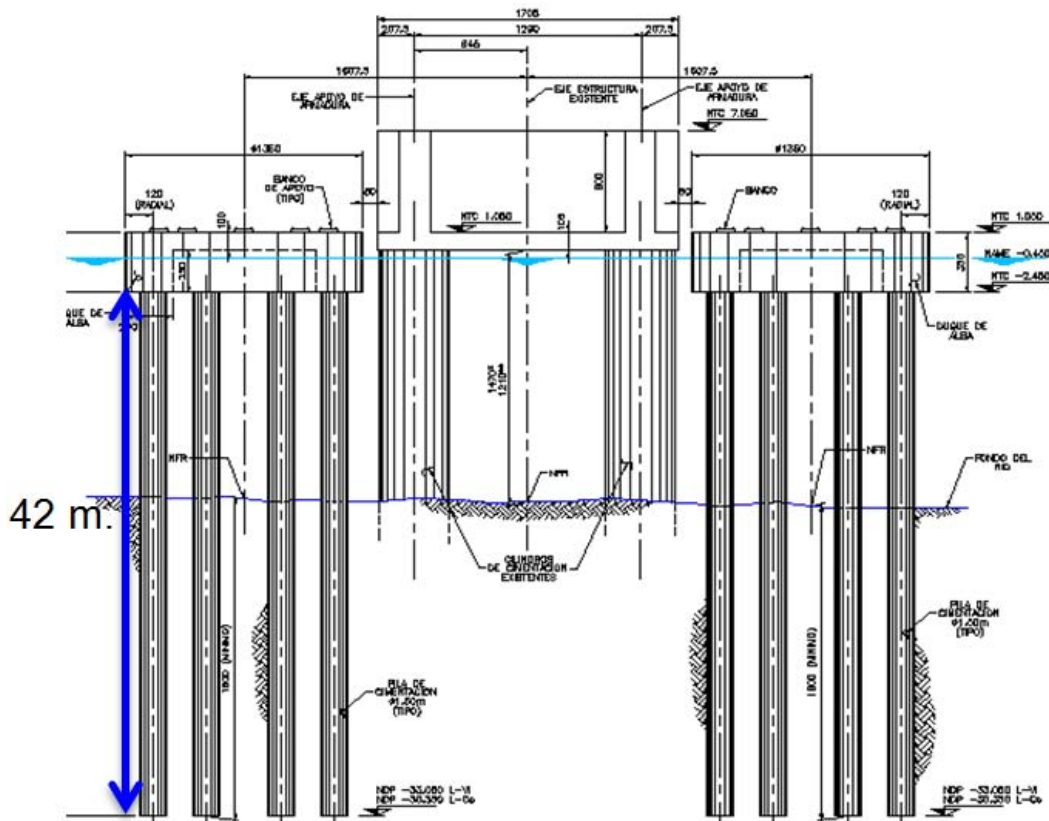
Profundidad de desplante de las pilas de cimentación de los duques de alba [1.3].
